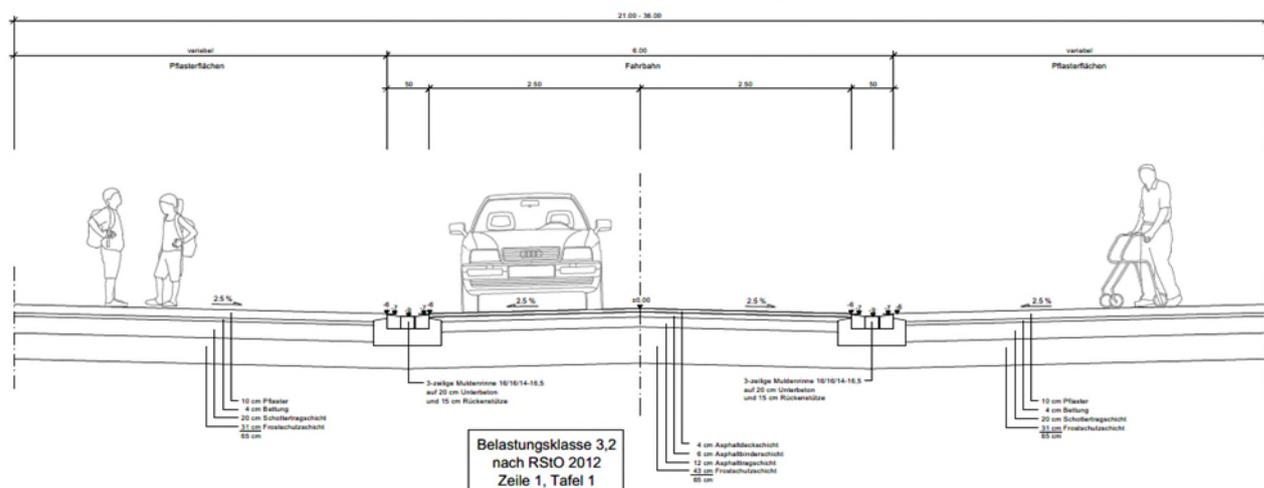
Regelquerschnitt Planstraße Urbane Achse, Darstellung IB Becker
